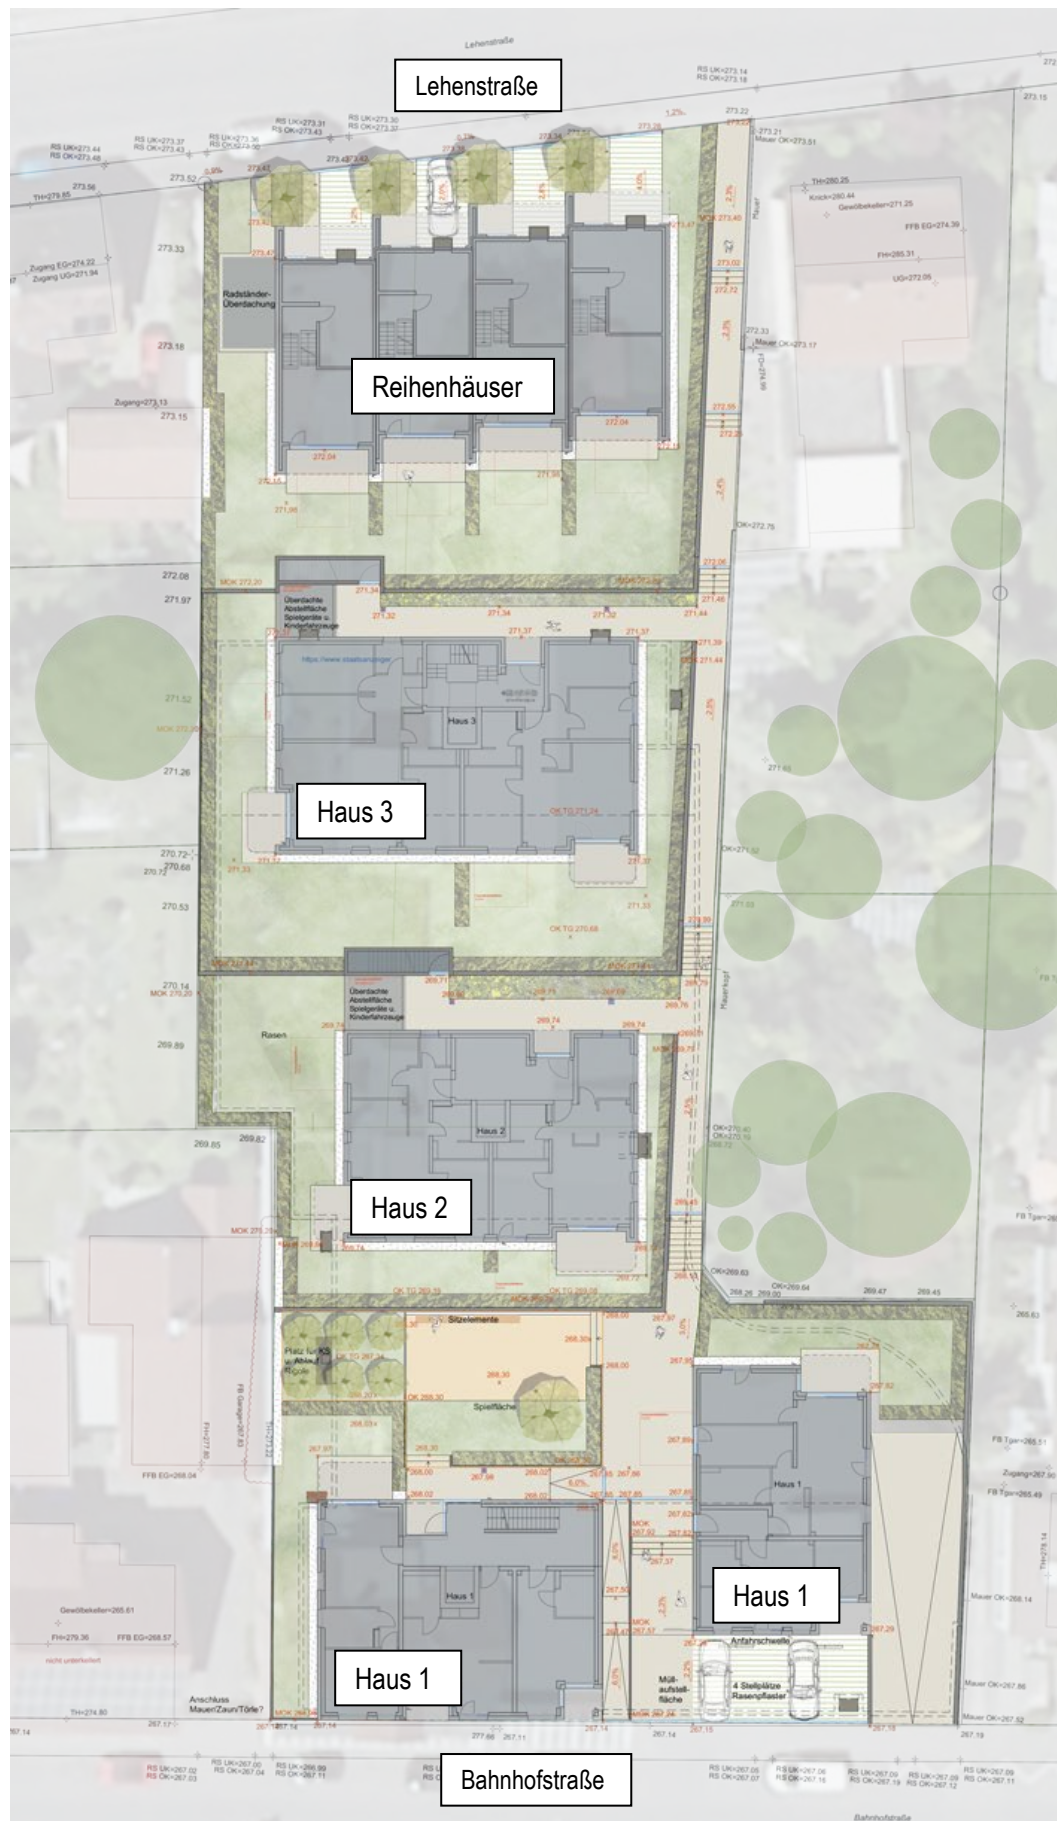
Lageplan - Vorhaben und Erschließungsplan, a+r Architekten GmbH, 14.09.2021
